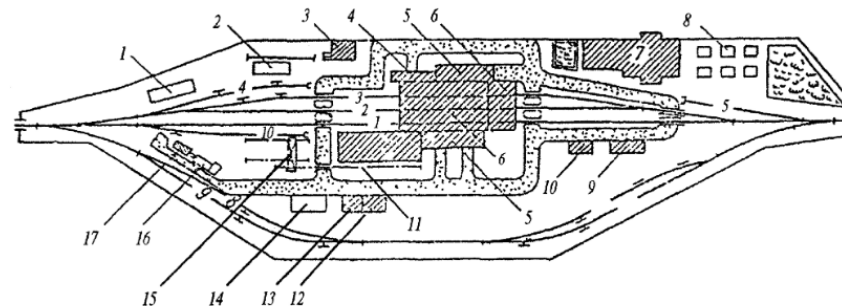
Схема вагонного депо: 1 — площадка для угля; 2 — угольный склад; 3 — котельная; 4 — служебно-технический корпус и бытовые помещения; 5 — мастерские; 6 — вагоноремонтный цех; 7 — деревообделочный цех; 8 — склад лесоматериалов; 9 — главный магазин; 10 — подзарядная аккумуляторная; 11 — цех по ремонту вагонов; 12 — цех по ремонту вагонов; 13 — цех по ремонту вагонов; 14 — цех по ремонту вагонов; 15 — цех по ремонту вагонов; 16 — цех по ремонту вагонов; 17 — цех по ремонту вагонов.
